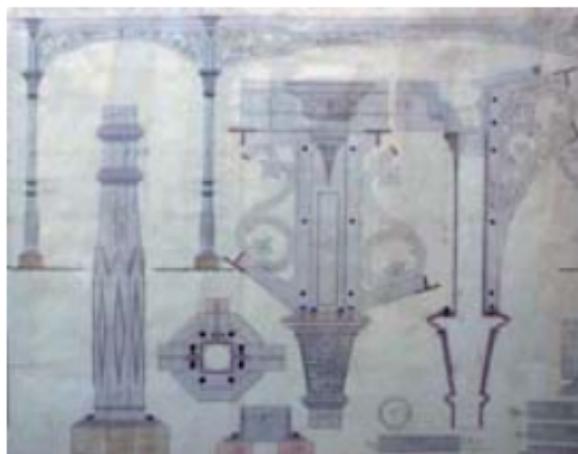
Un acercamiento del plano original de los detalles constructivos para una marquesina de la estación Buenavista. Anónimo, 1882. En: Museo del Ferrocarril, Puebla. Foto: RV, 2006
